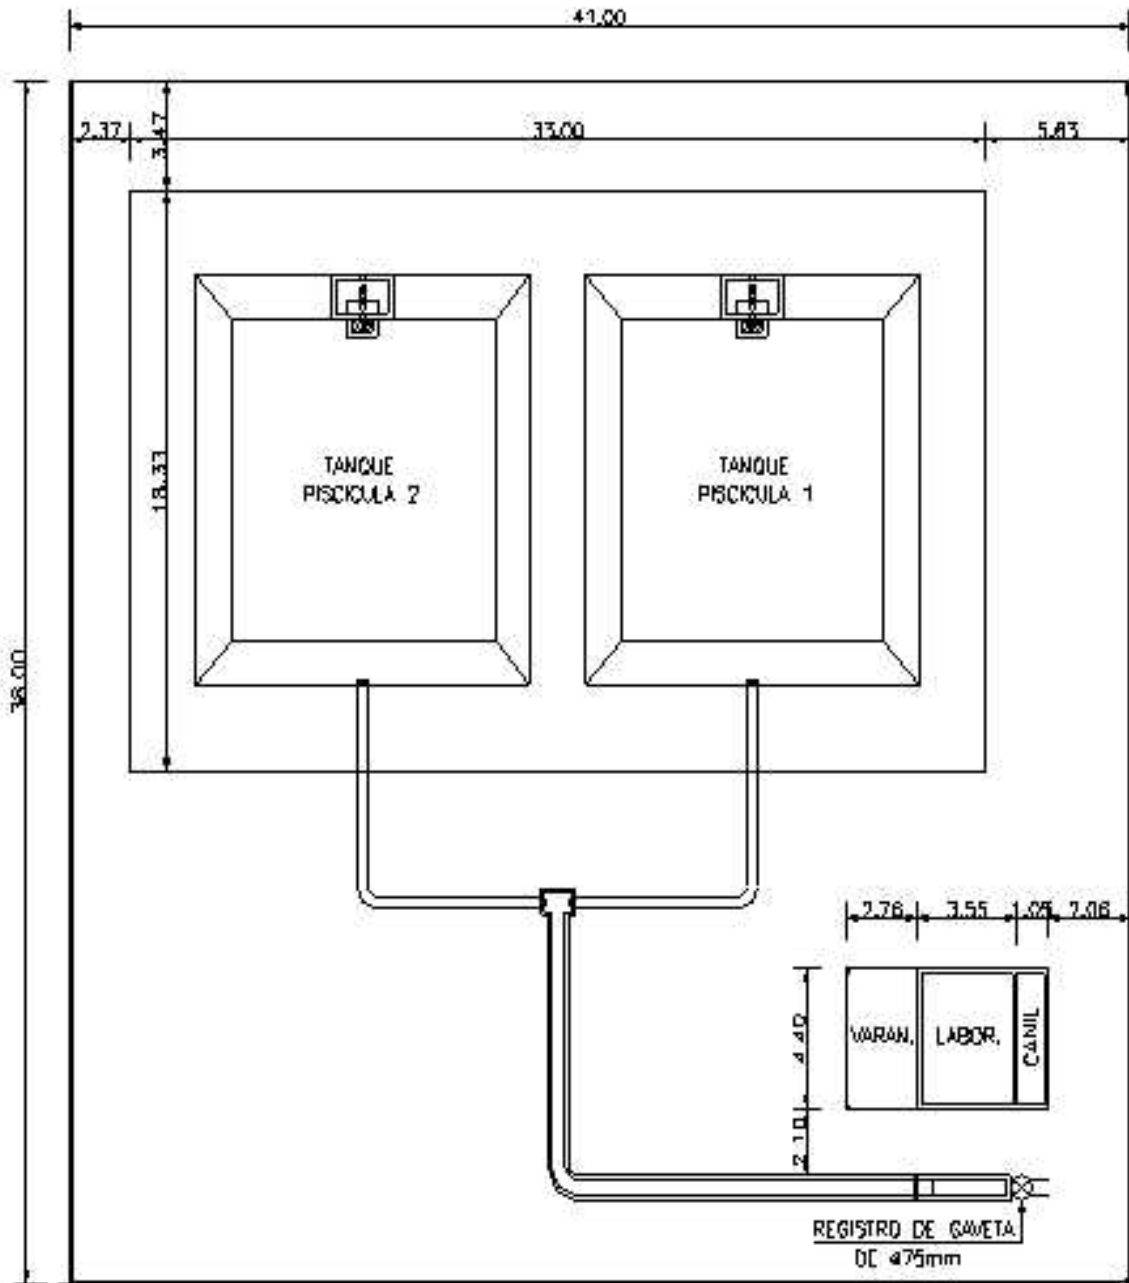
Croquis da Unidade Piloto (vista em planta)
